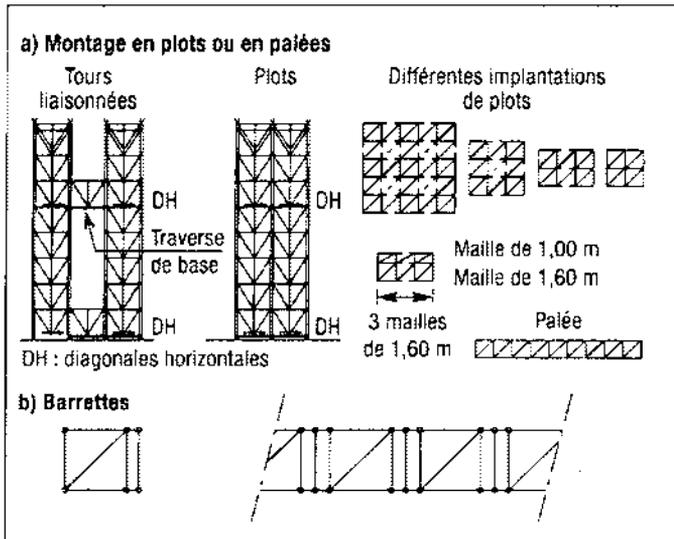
Montage en plots et en palées (a), ajouts de barrettes (b).
